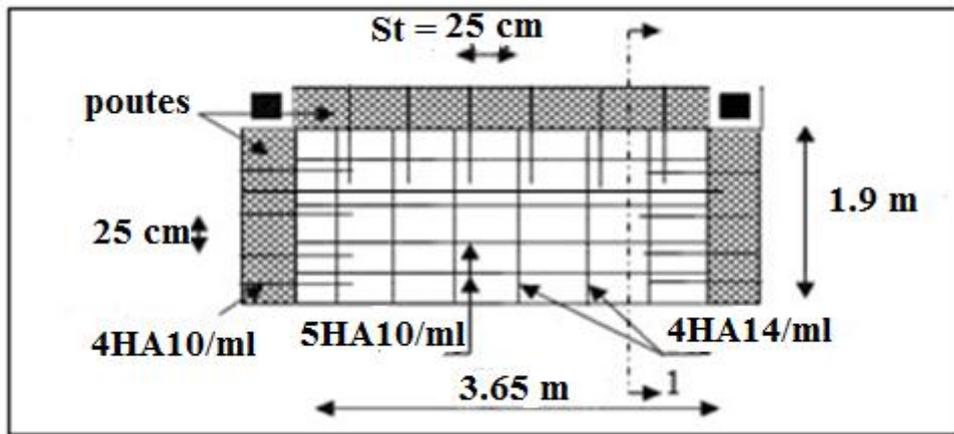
Schéma de ferrailage de la dalle sur 3 appuis.
